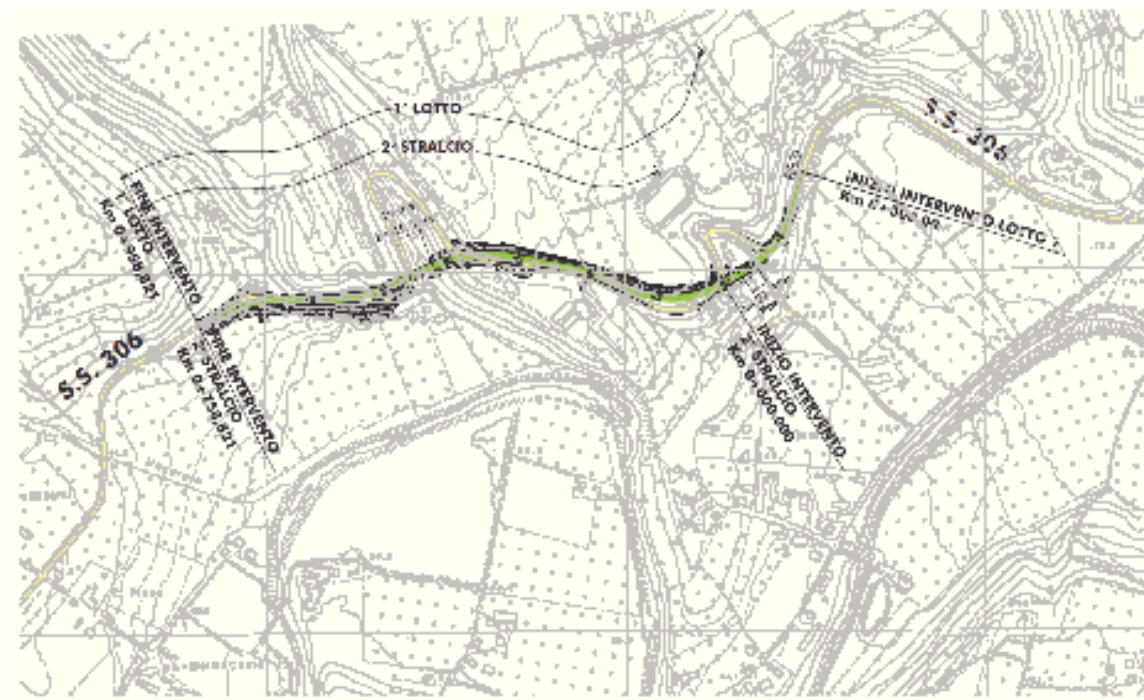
Planimetria di progetto 1 Lotto Stralcio 2
